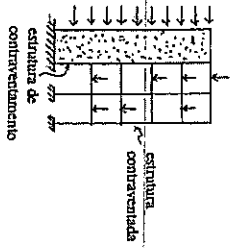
Estrutura contraventada e estrutura de contraventamento
